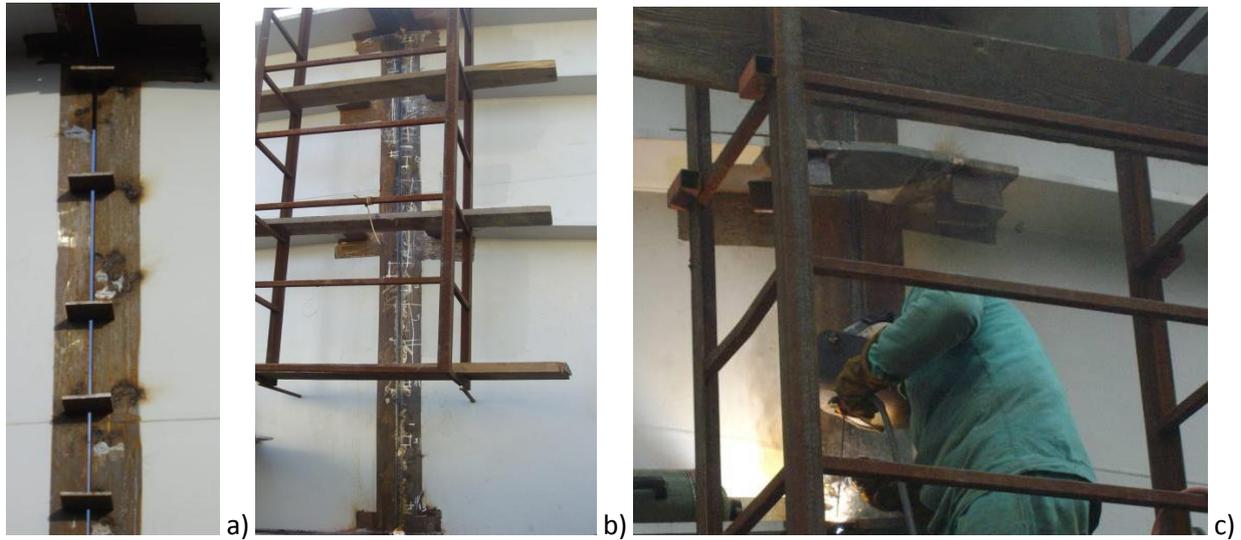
a) Posizionamento delle clampe nella giunzione testa a testa della trave principale; b) posizionamento della struttura di accesso per il saldatore; c) saldatura manuale.
